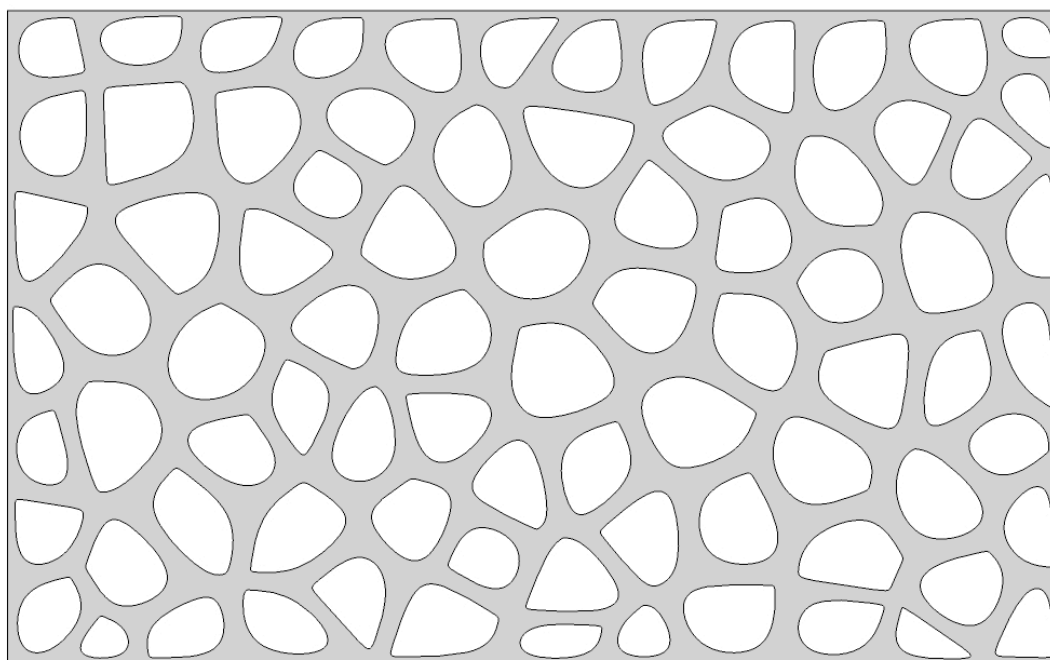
Painel Final - Fachada Sudeste. FONTE: Autor
